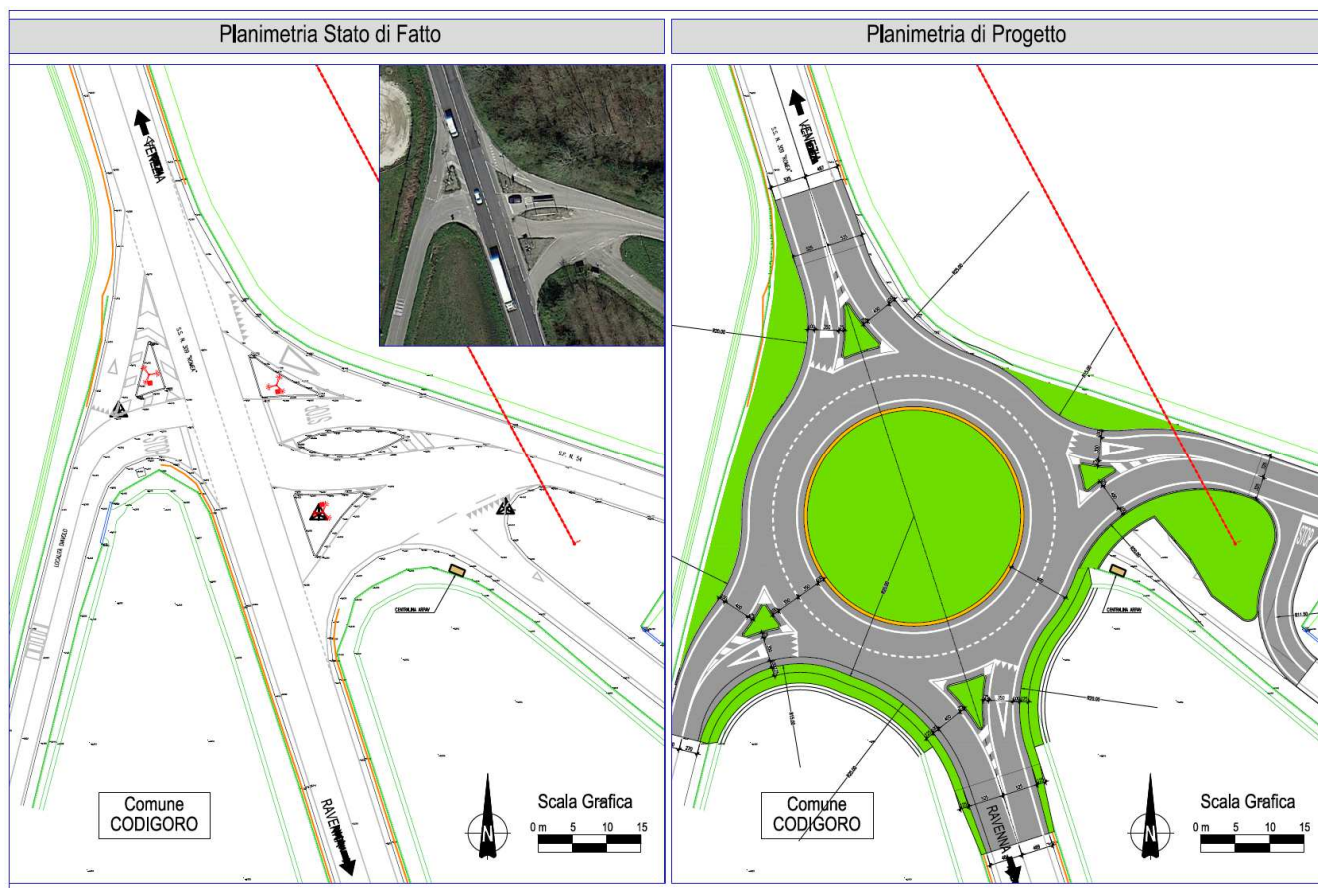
Intervento n°17 – Planimetria Stato di fatto - Progetto
